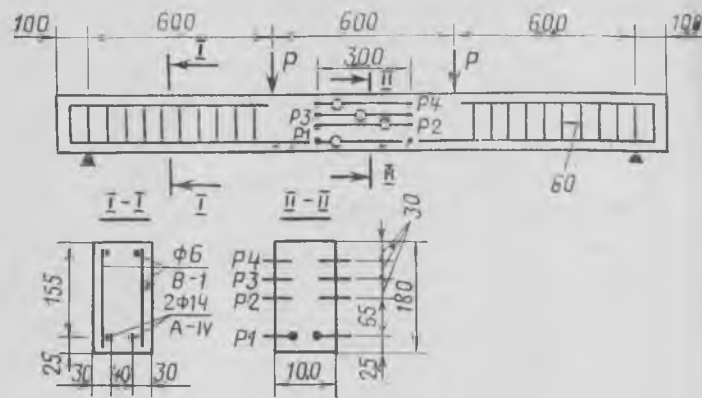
Конструкция, схемы нагружения опытной железобетонной балки и расположения реперов (P1...P4) для замера продольных деформаций
